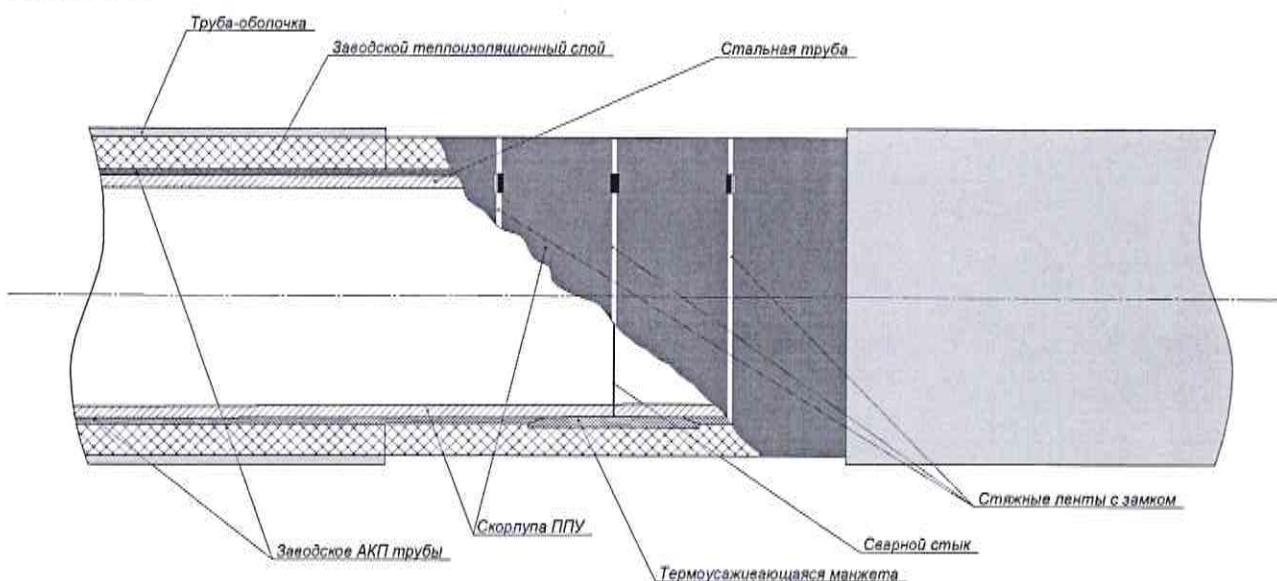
Конструкция теплоизоляции с сварного стыка труб надземной прокладки перед установкой гидроизоляции теплоизоляционного слоя
